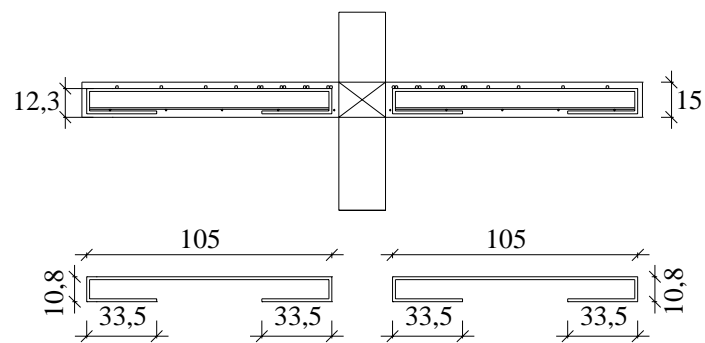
Armadura de flexão das lajes L7 e L8, L11 e L12 (cm)
